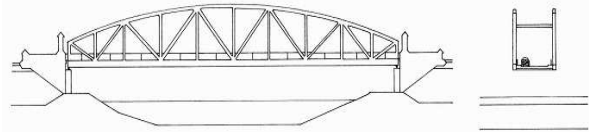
Trogbrücke mit randseitigem Stahlfachwerk
